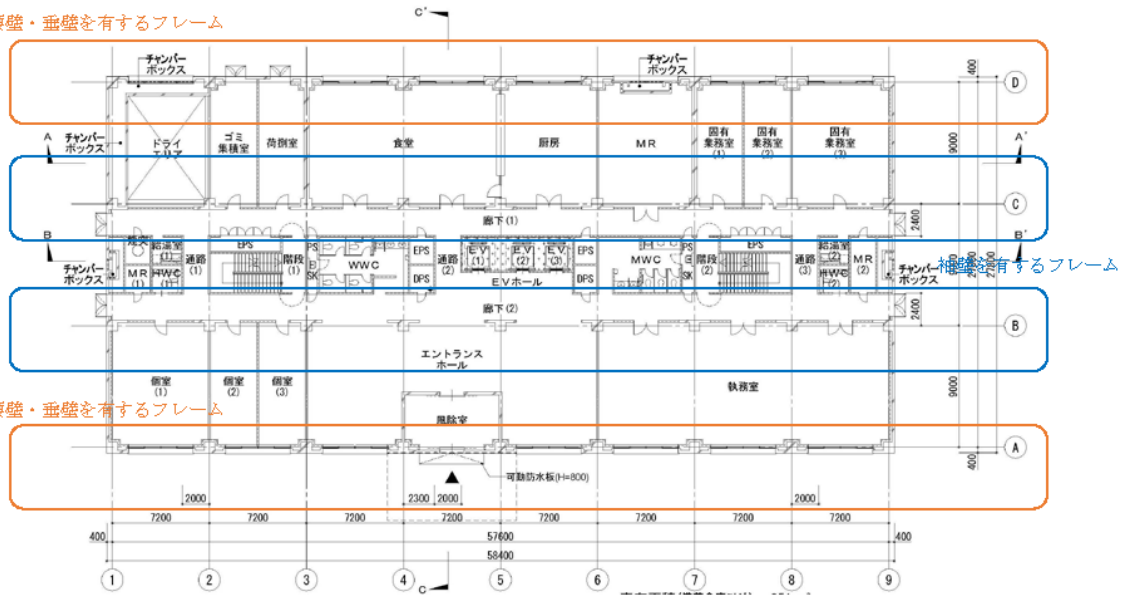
内陸型 1 階平面図 (袖壁・垂れ壁・腰壁を有するフレームを図示)
